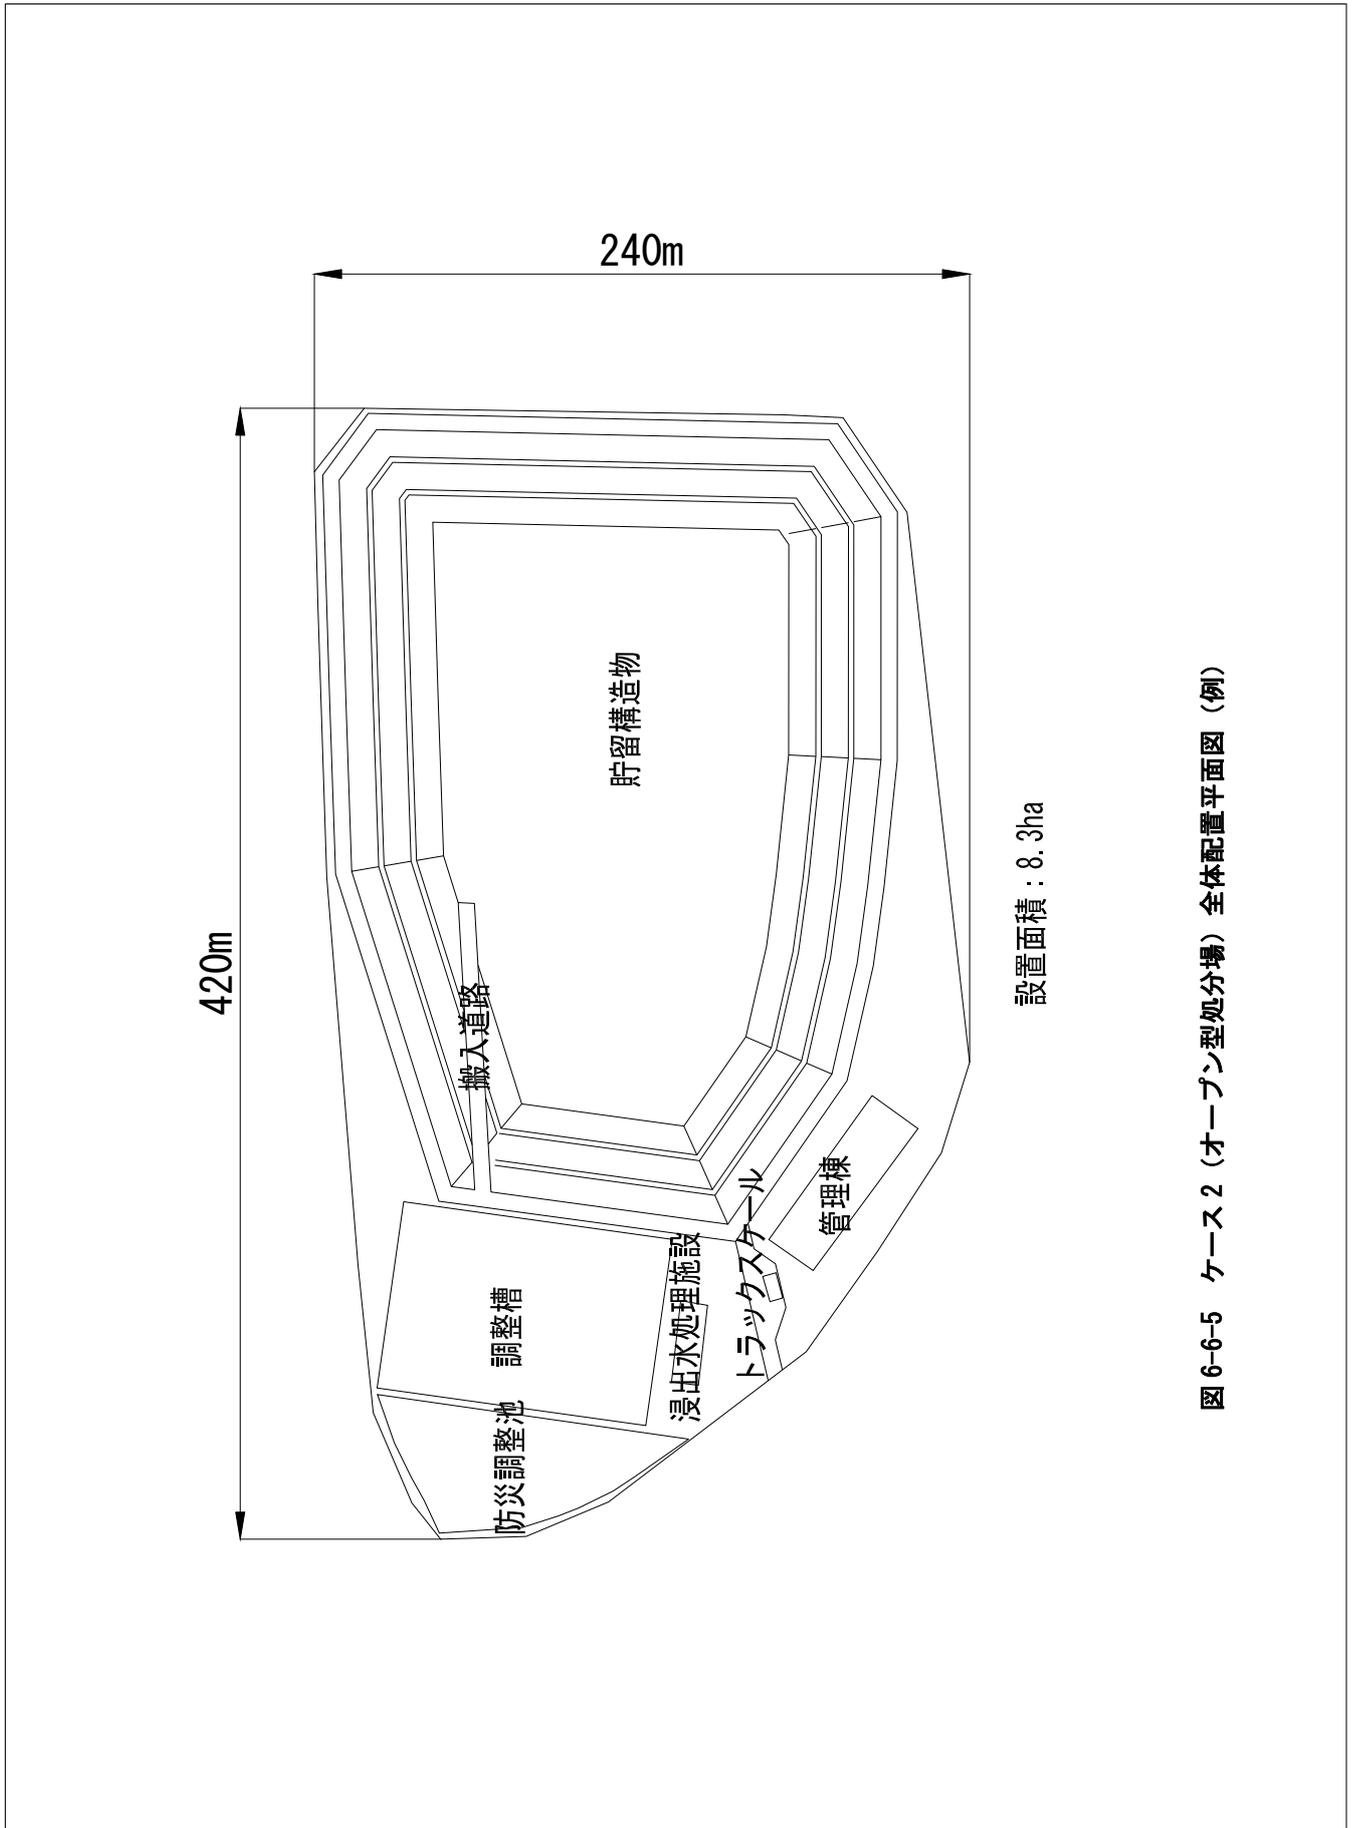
ケース 2 (オープン型処分場) 全体配置平面図 (例)
